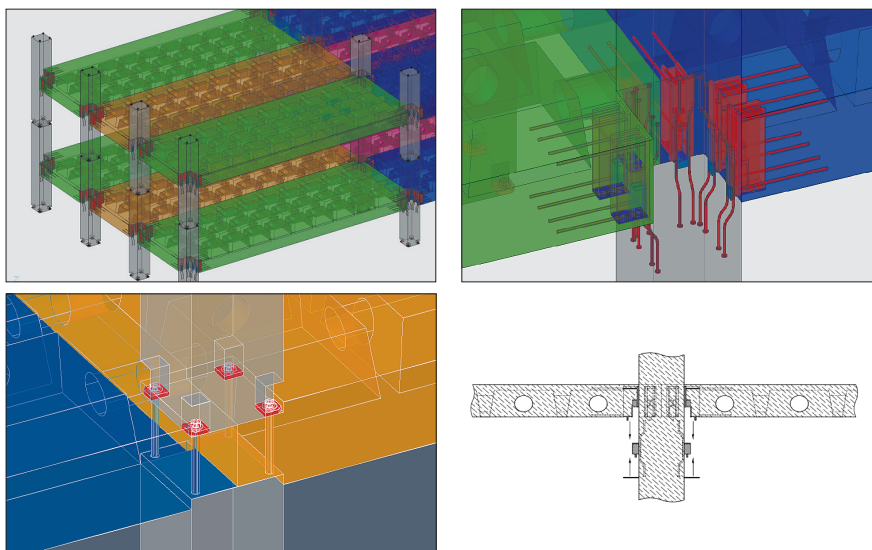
Общий вид строительной системы БМПЗ в железобетонном исполнении
